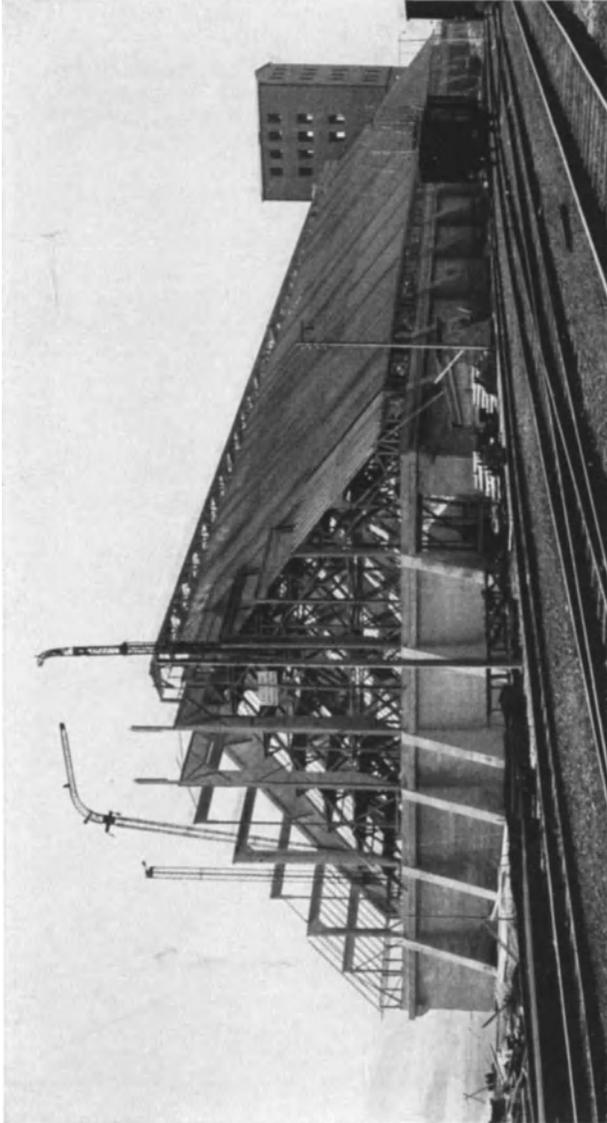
Halle im Bau — kurz vor der Vollendung.
